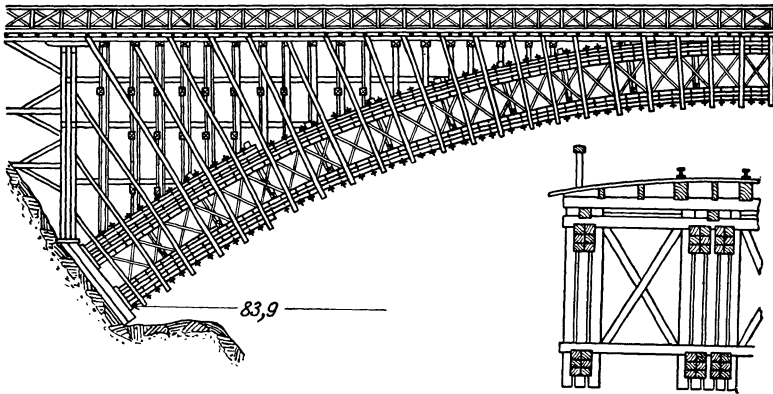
Ehemalige Cascadebrücke der Erie-Eisenbahn (Nordamerika) mit Fachwerkbogen.
